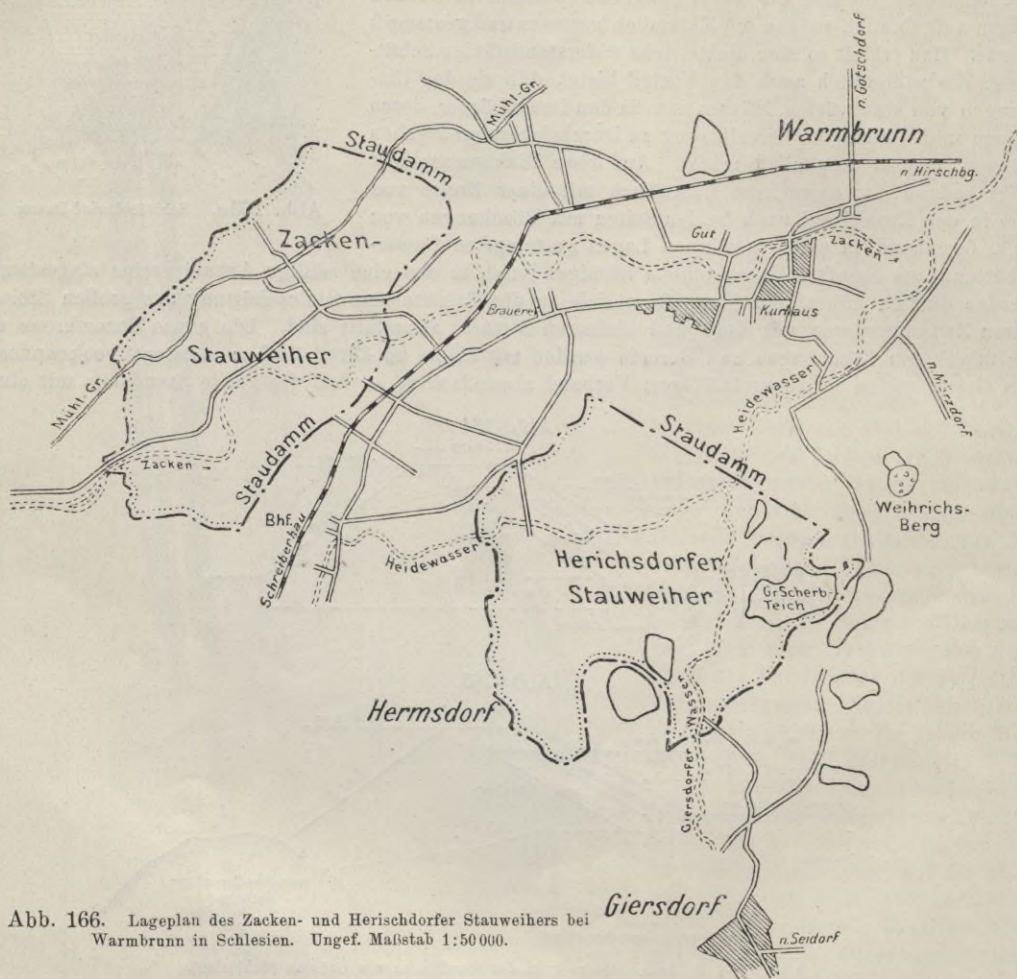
Lageplan des Zacken- und Herischdorfer Stauweihers bei Warmbrunn in Schlesien. Ungef. Maßstab 1:50 000.
